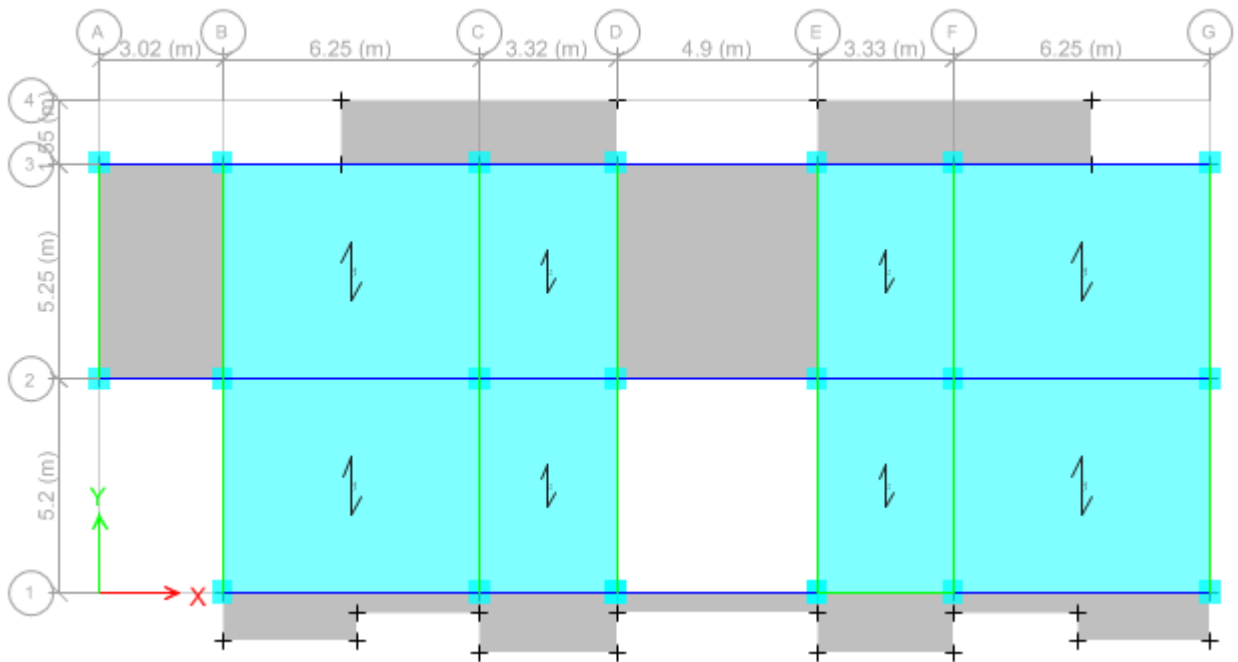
Plans Disposition des poutrelles étage 3,4,5,6,7
